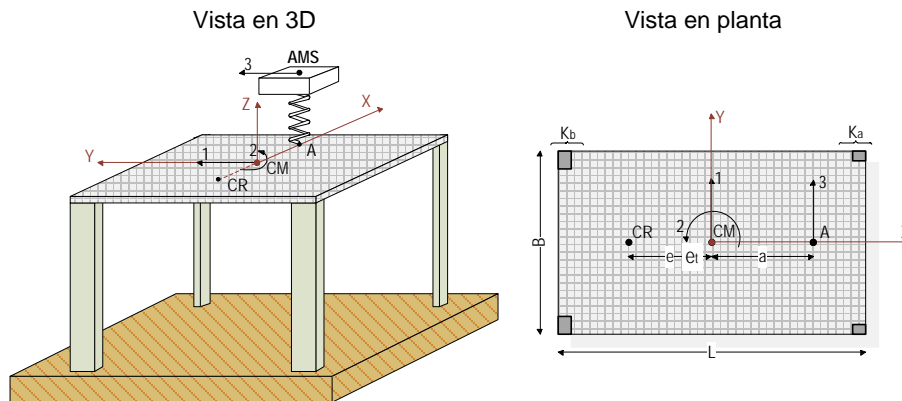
Vista tridimensional y en planta del modelo torsional con AMS
